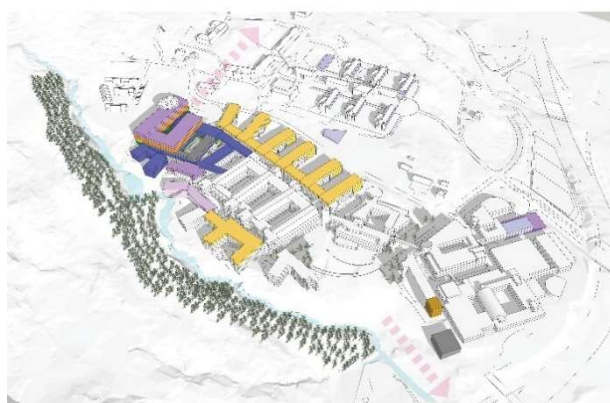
Farger benyttet for å illustrere funksjoner (første runde med mulighetsstudier)
